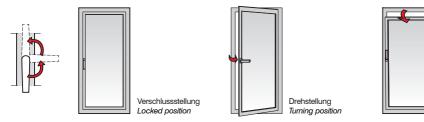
Einstellungen bei abschließbaren Fenstertüren Fig.25: Positions for lockable casement doors
